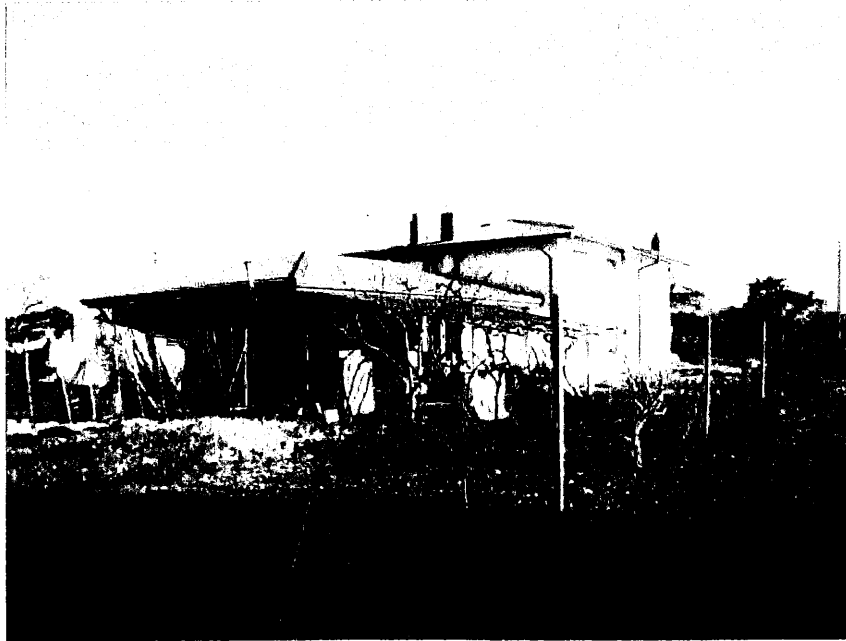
vista prospetto nord - ovest del fabbricato residenziale e accessorio
